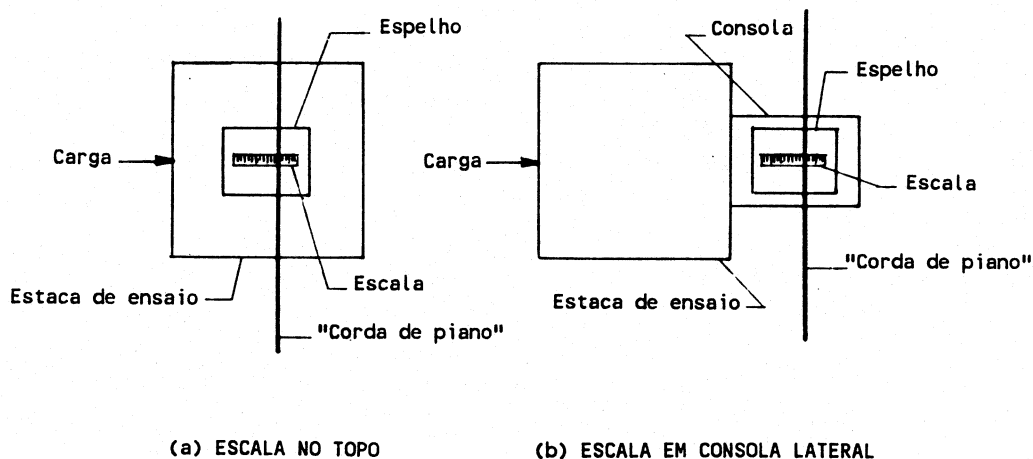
Sistema de medição de deslocamentos horizontais tipo corda/escala - Planta (Adaptado de ASTM D3966, 1990)
